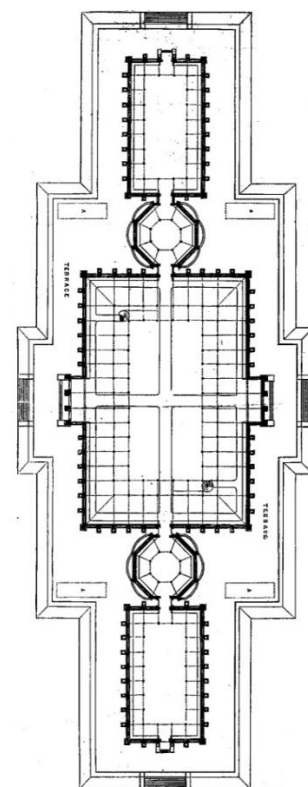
Planta de La Casa Templada del Real Jardín Botánico de Kew
